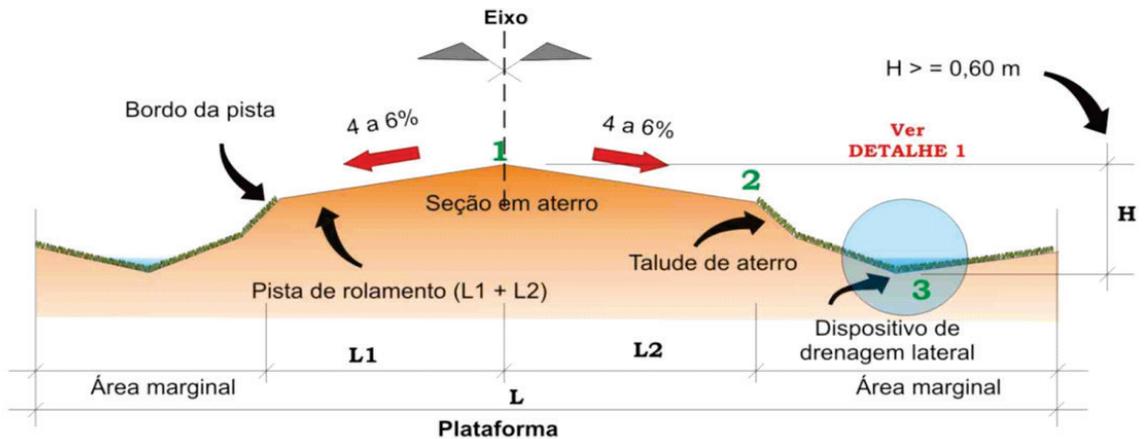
Conformação de uma estrada ideal para relevo plano ou levemente ondulado.
